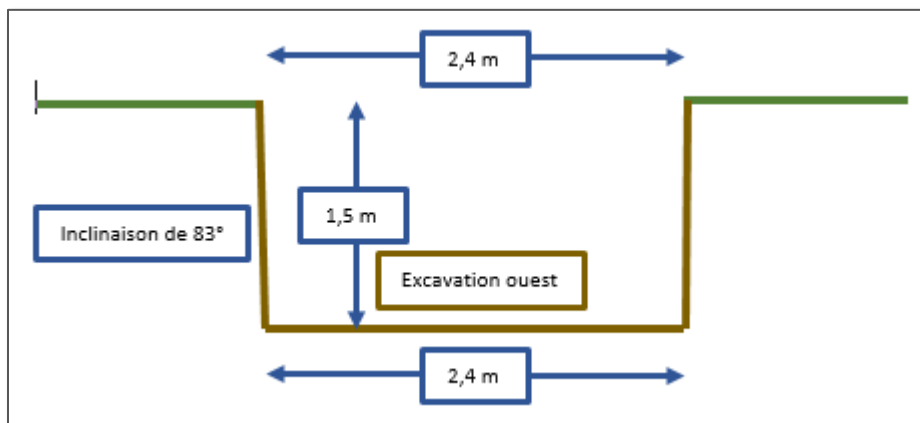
Caractéristiques de la tranchée ouest de l'excavation où le travailleur bénévole a été projeté
